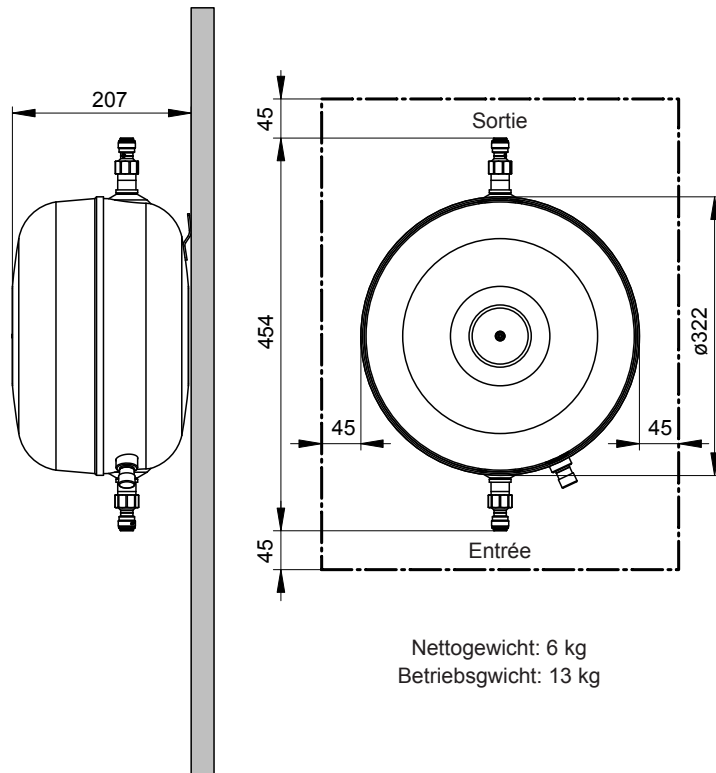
Dimensions réservoir de débit (dimensions en mm)
